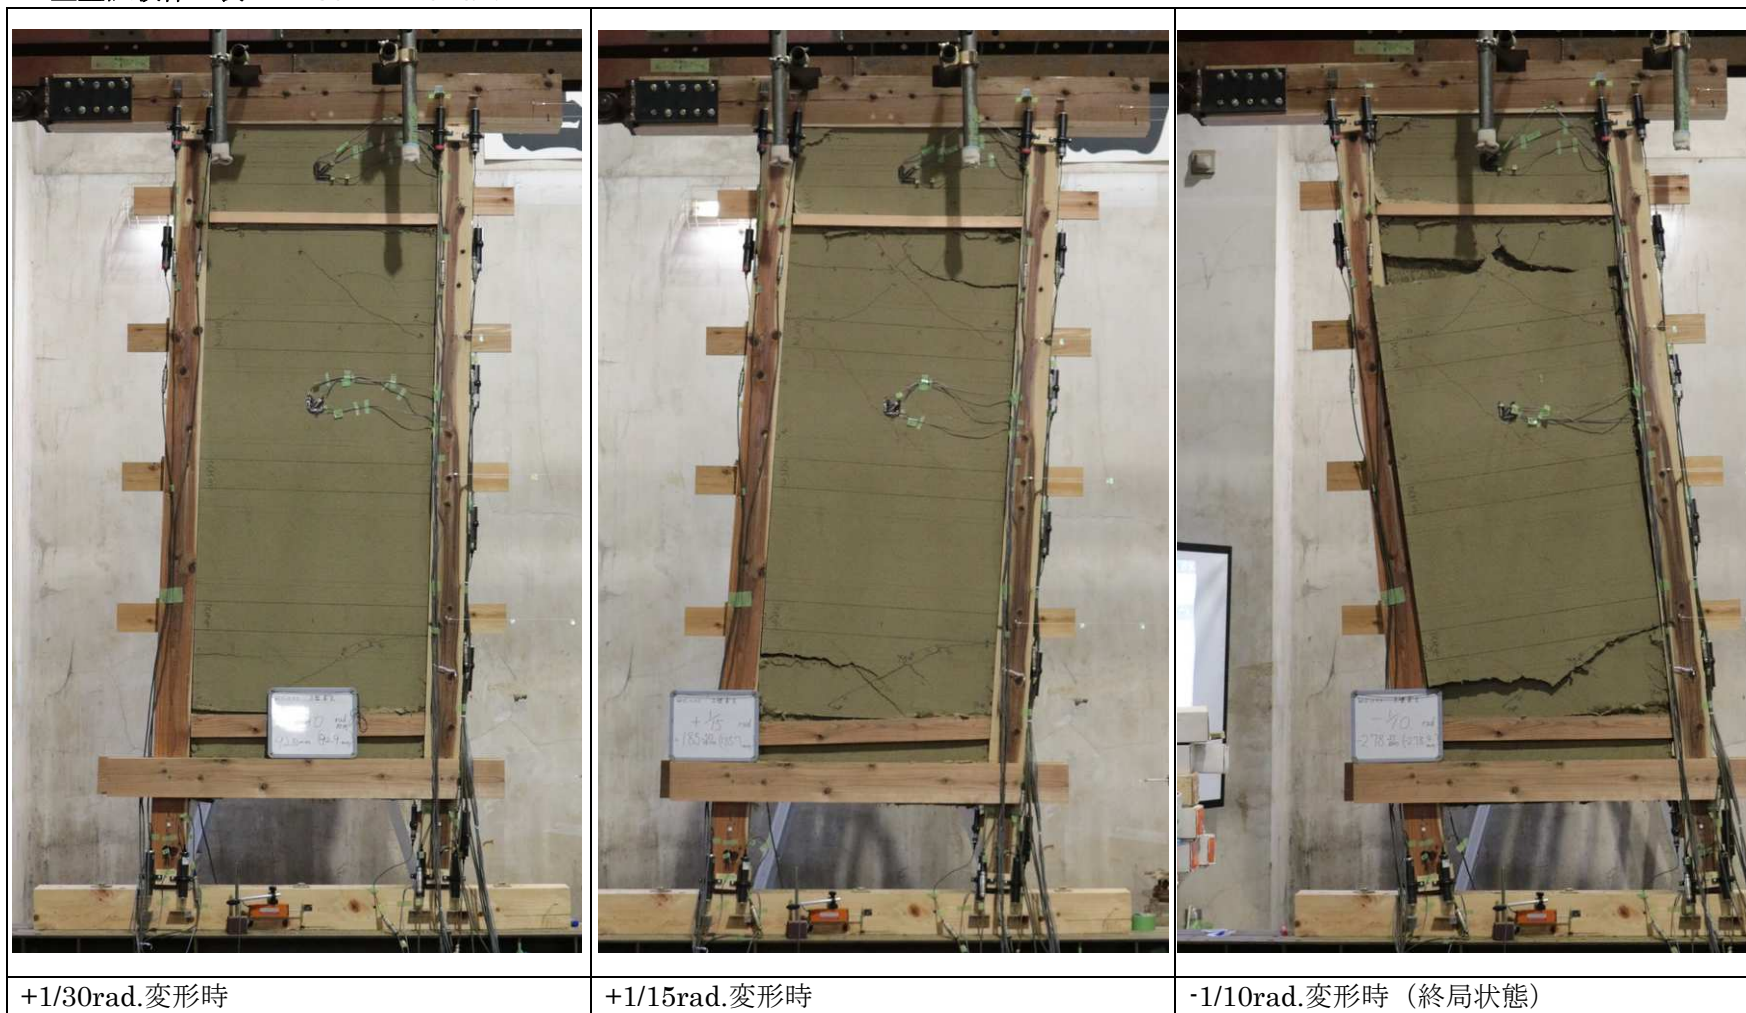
土壁試験体 表 +1/30 - -1/10 rad.
